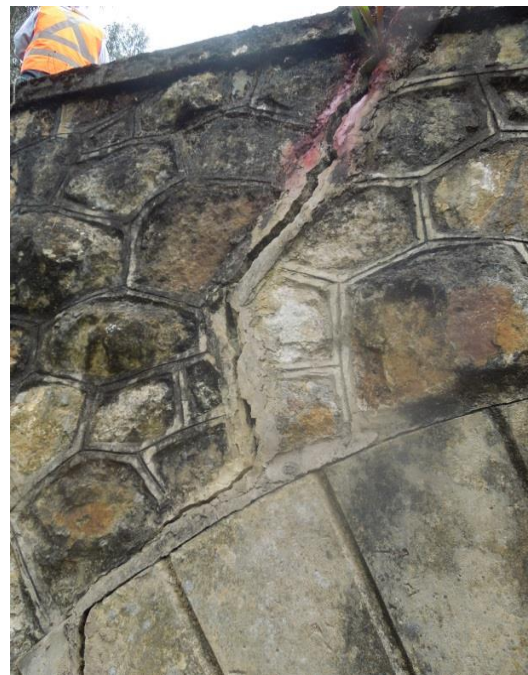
Arco #1. Detalles fisura A1F2.
